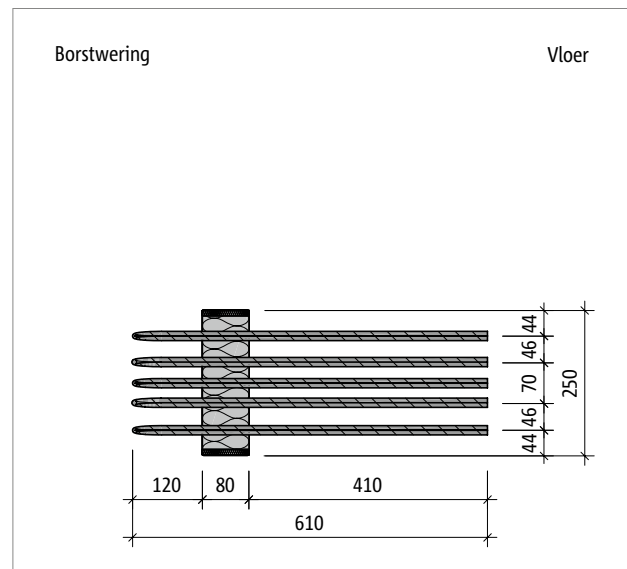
Schöck Isokorb® T type A: Doorsnede
